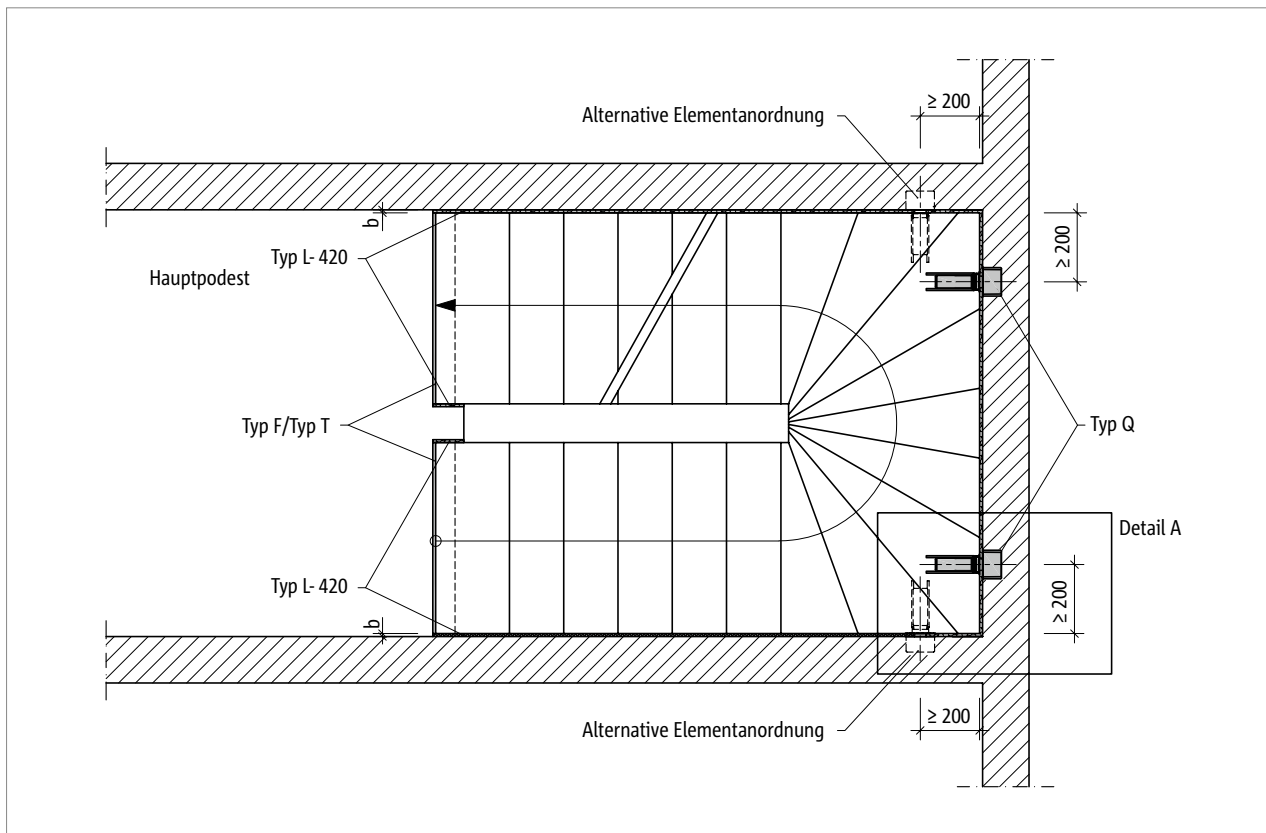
Tronsole® Q: Elementanordnung im Grundriss mit Verwendung der Tronsole® L
